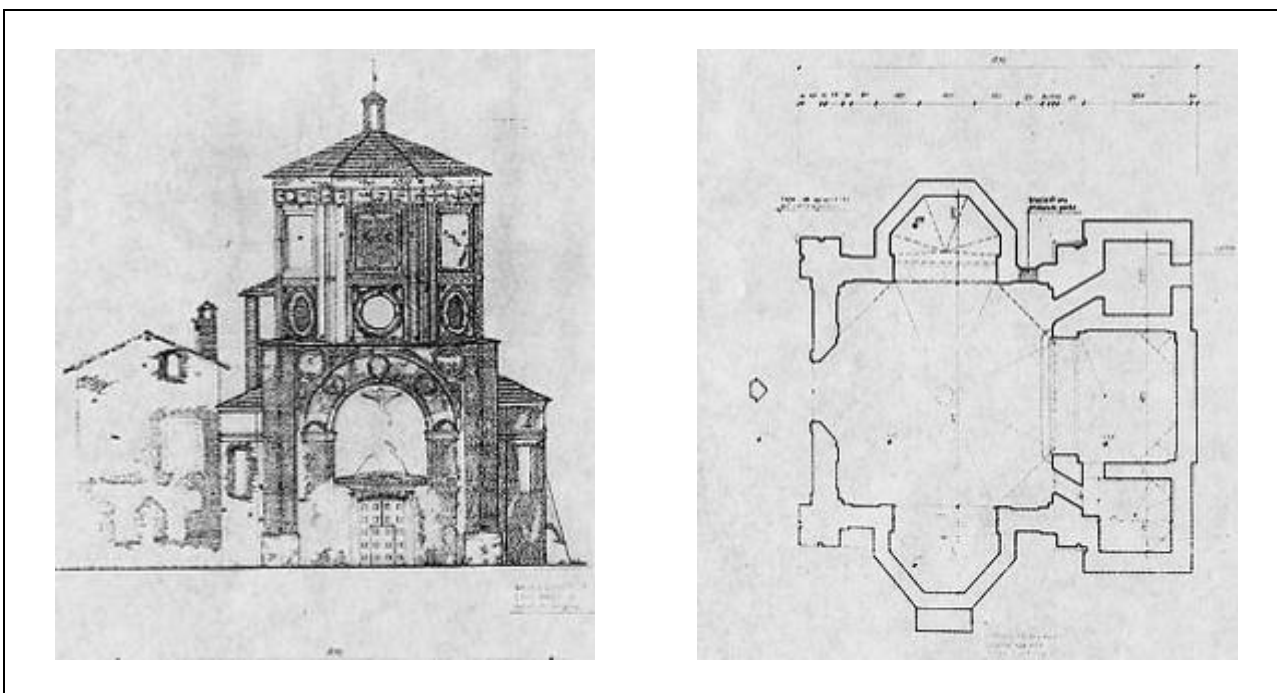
Pianta e prospetto da archivi storici (Fonte Web)
